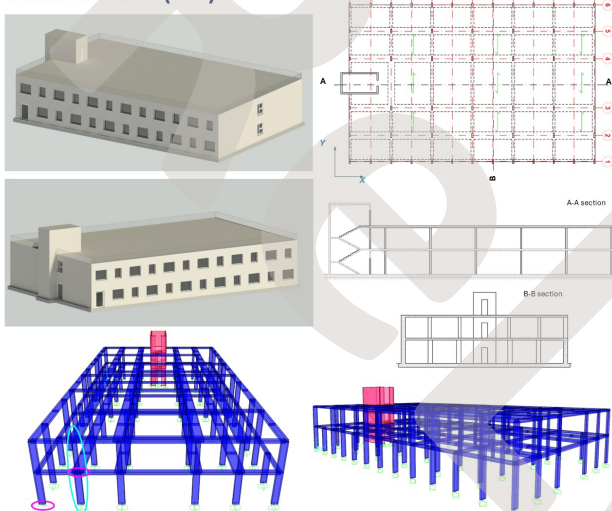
Pianta, sezioni, viste 3D e modello FEM della struttura allo stato di fatto
